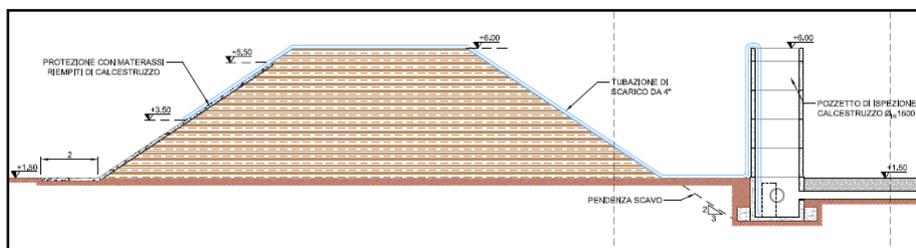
Sezione argine interno con particolare della protezione dei materassi in geotessile riempiti di calcestruzzo
